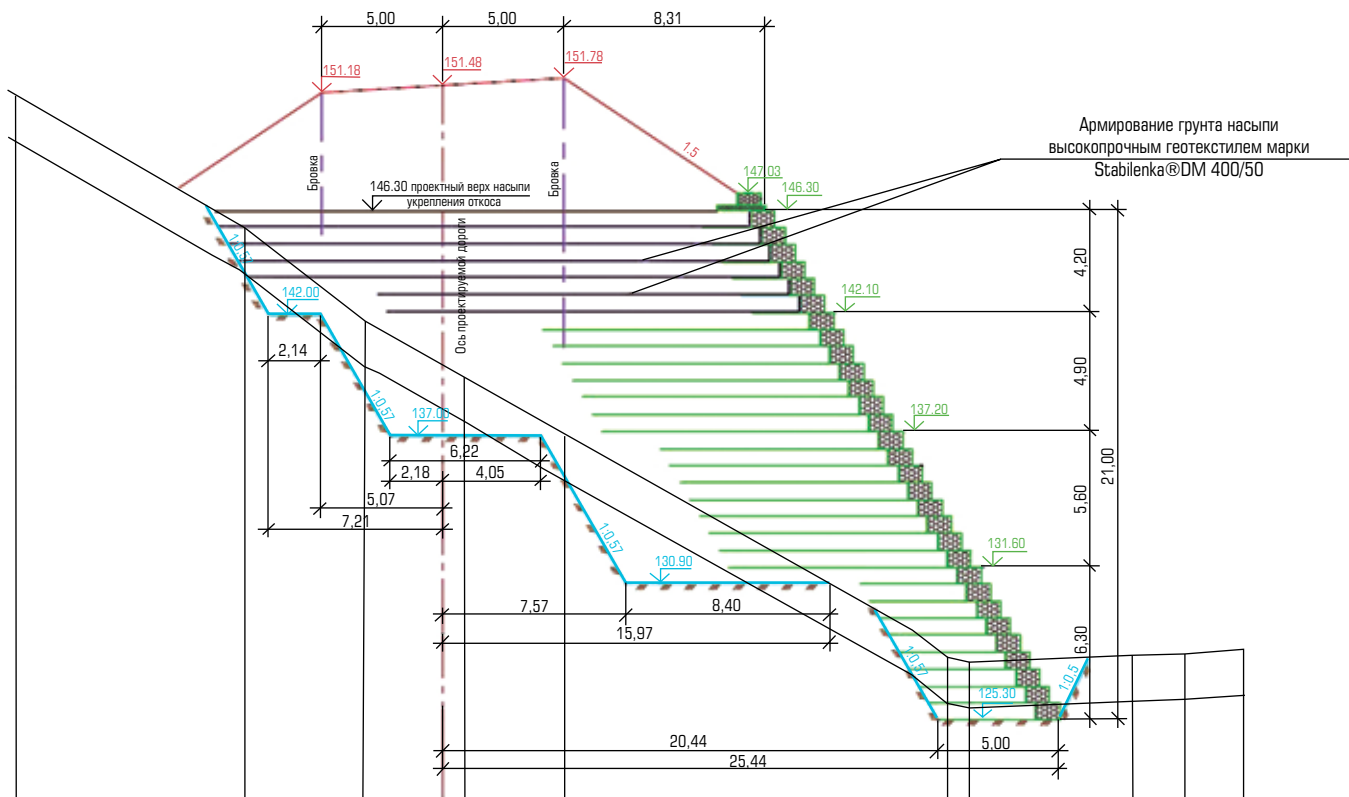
Поперечное сечение. Армирующий материал — Stabilenka® 400
